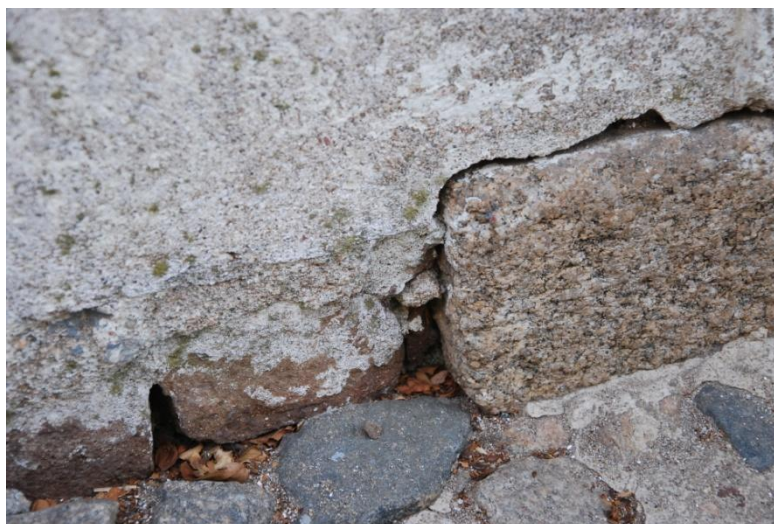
Tijolos maciços com argamassa tradicional de cal na fachada exterior, em contacto com o pavimento da rua e pedra de cantaria da porta (Travessa da Bota)
